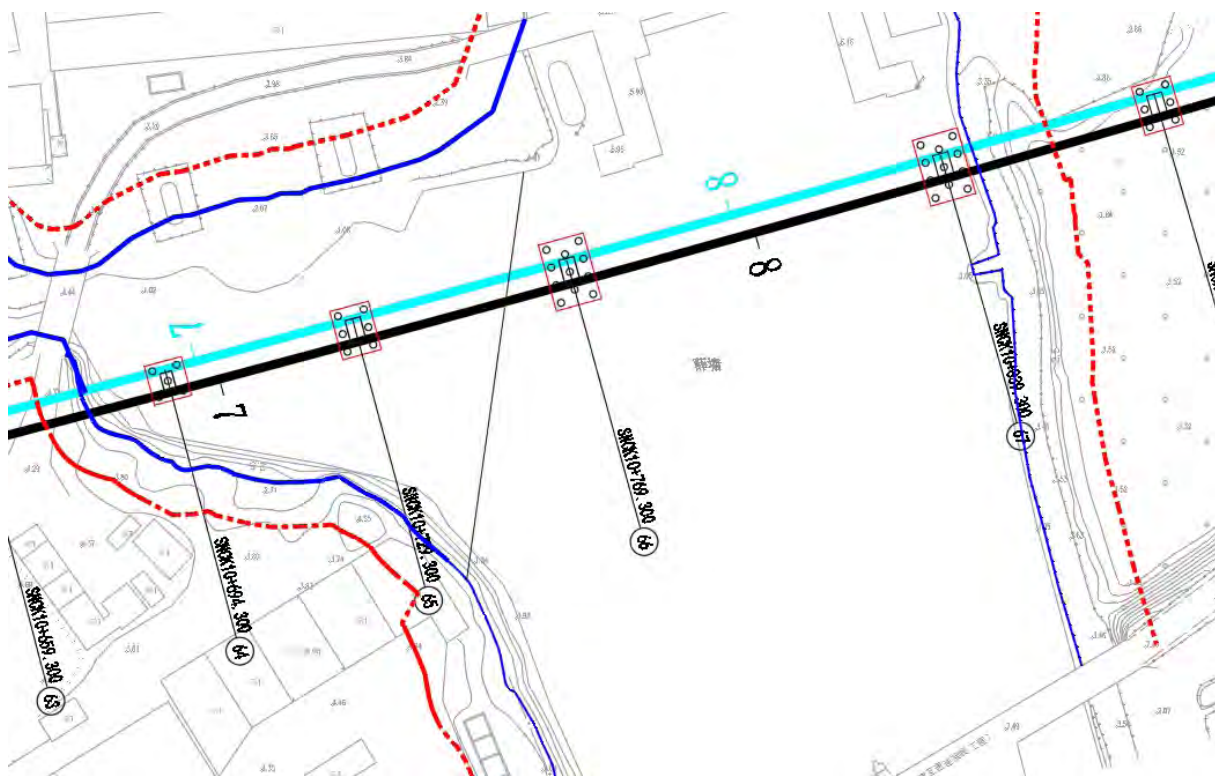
水乡旅游线跨浔练公路特大桥跨息塘桥梁平面布置图
